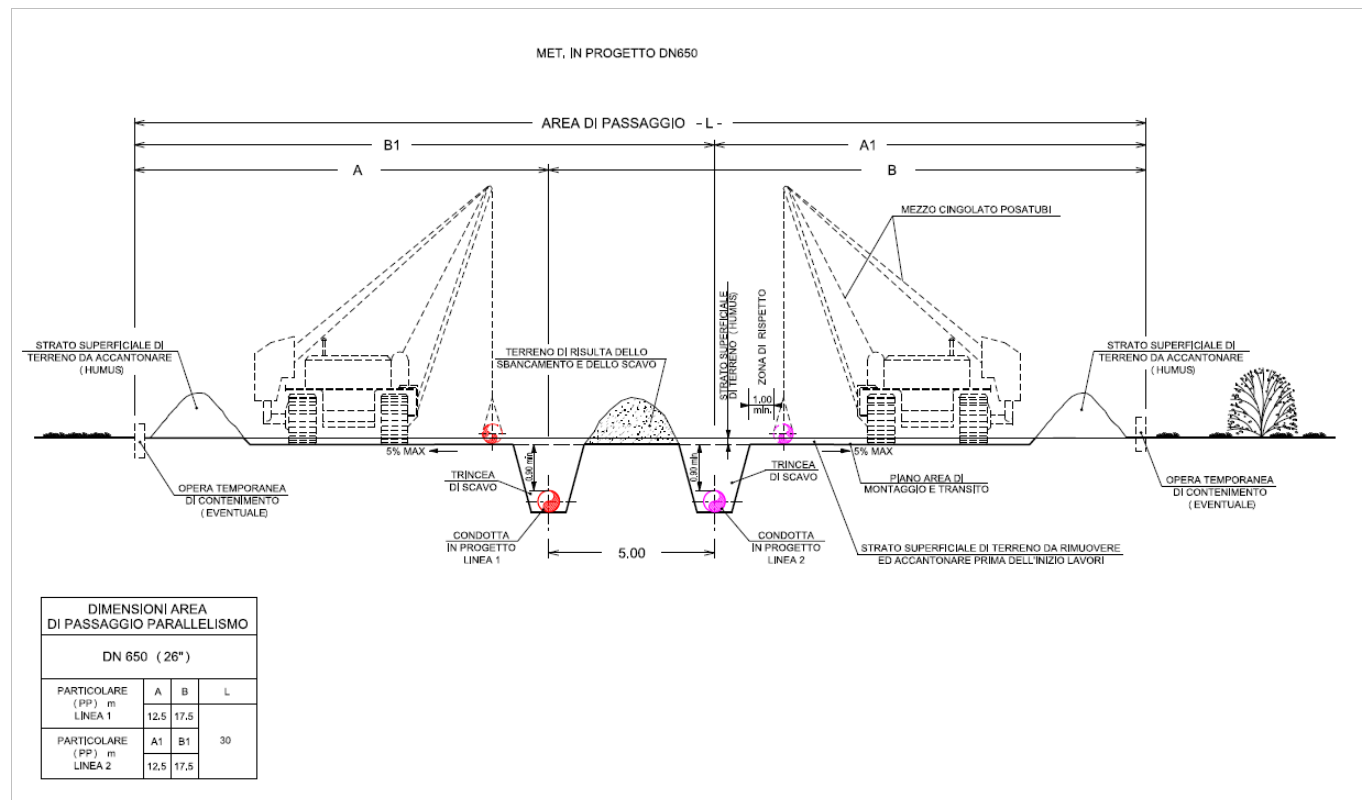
Sezione tipo dell'area di passaggio per doppia condotta DN 650
